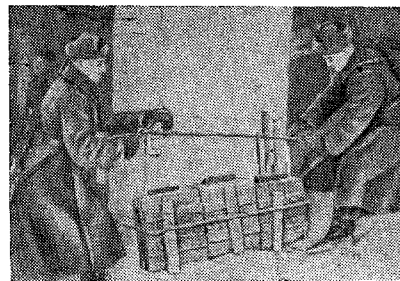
Крепление зарядов к стойкам железобетонного моста с помощью стяжных хомутов.
